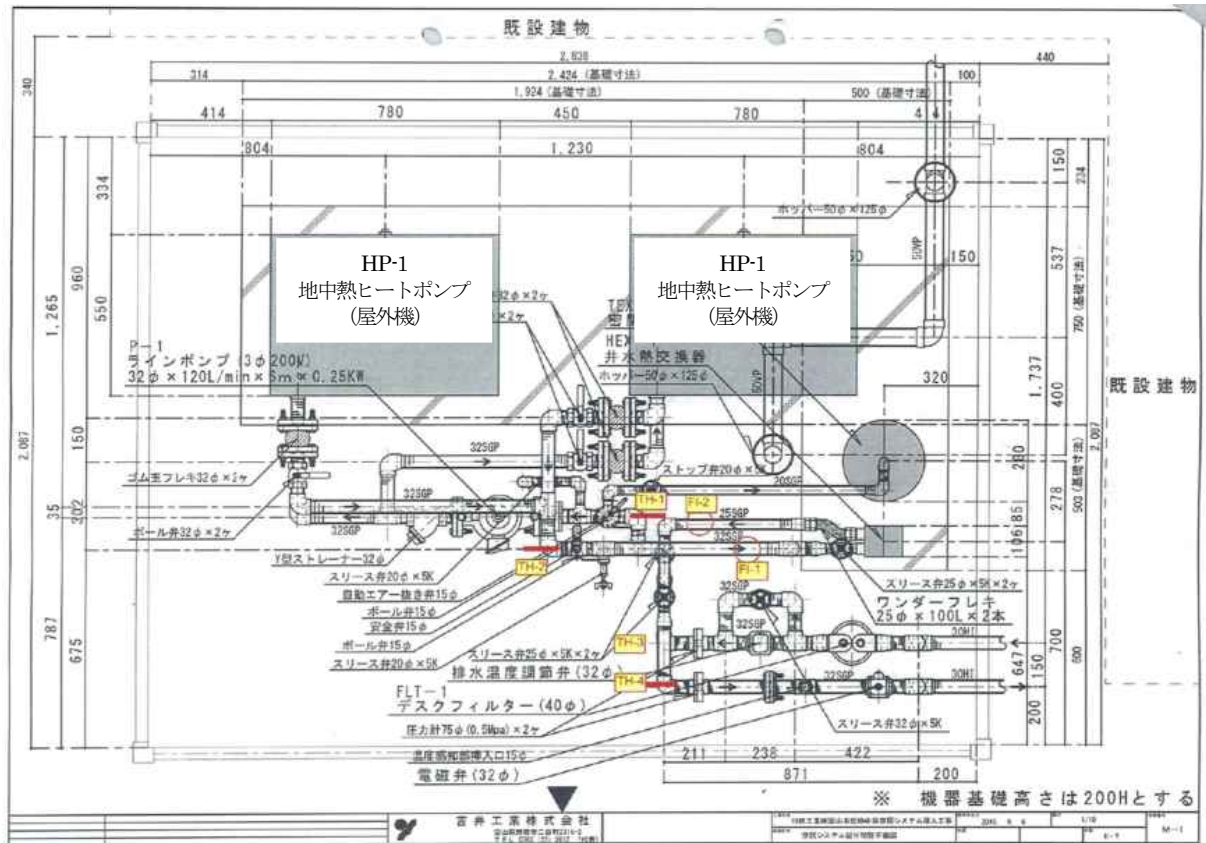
実証試験実施設備（下記の図 4-3 参照）の平面図
